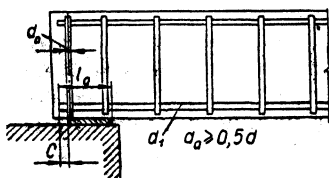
Анкеровка сварных арматурных каркасов балок на свободной опоре.
